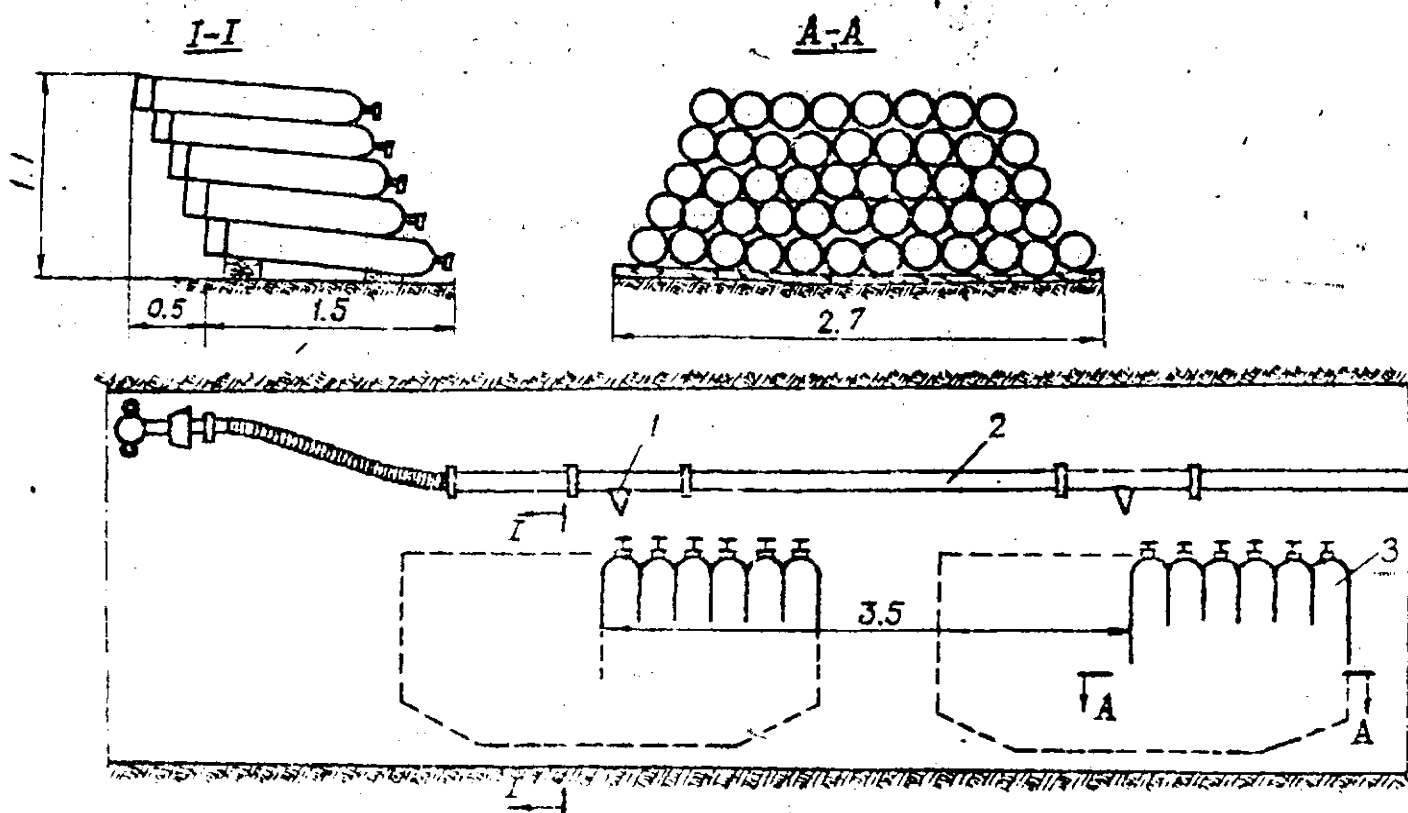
Схема размещения для углекислого газа установкой УВУ
